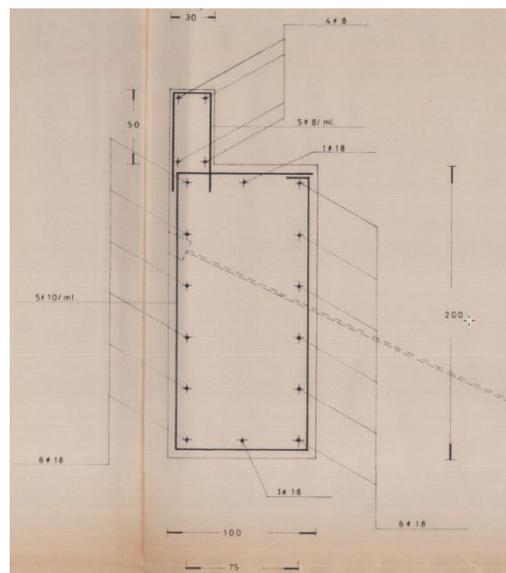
Estratto da Sezione trasversale e particolari – progetto del 1987
